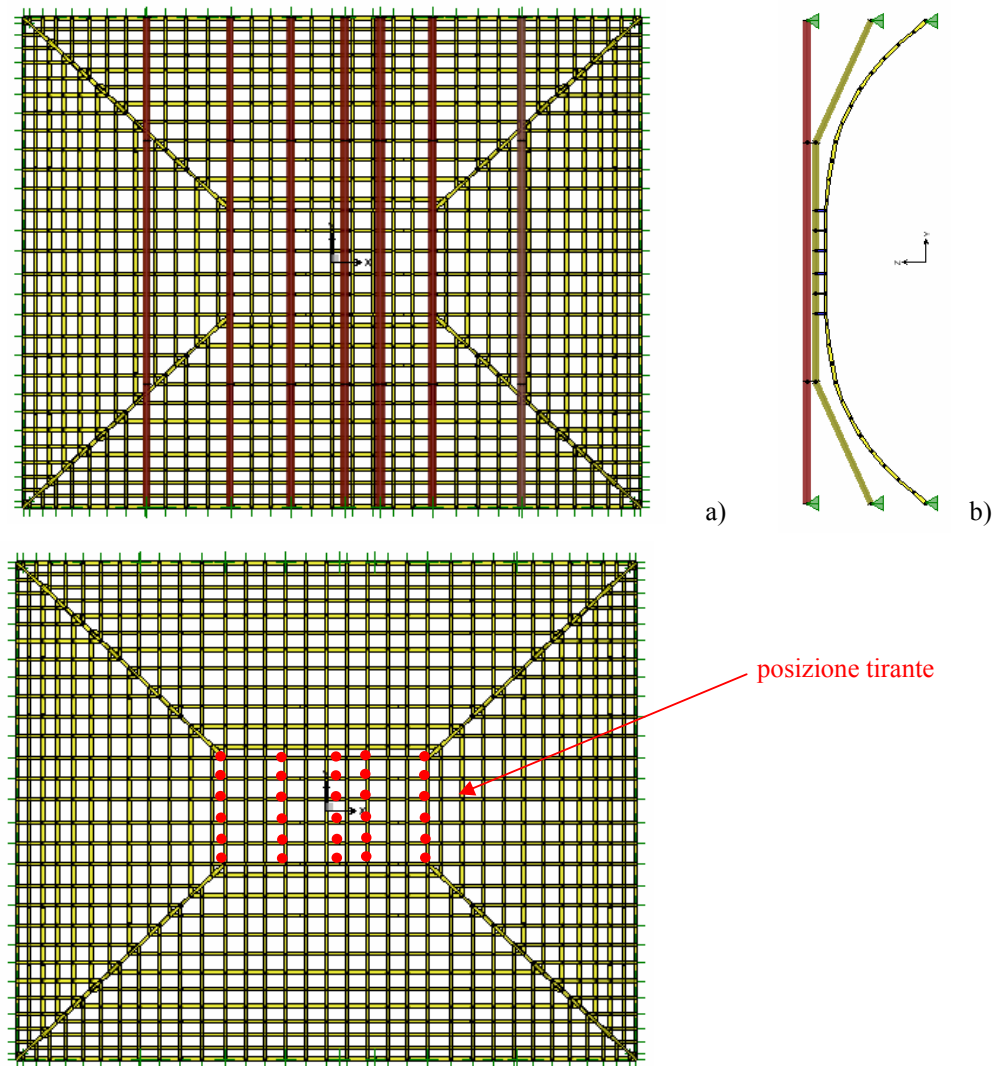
Sistema volta-struttura di sostegno: a) Pianta; b) Sezione tipo YZ; c) Posizione in pianta dei tiranti.
